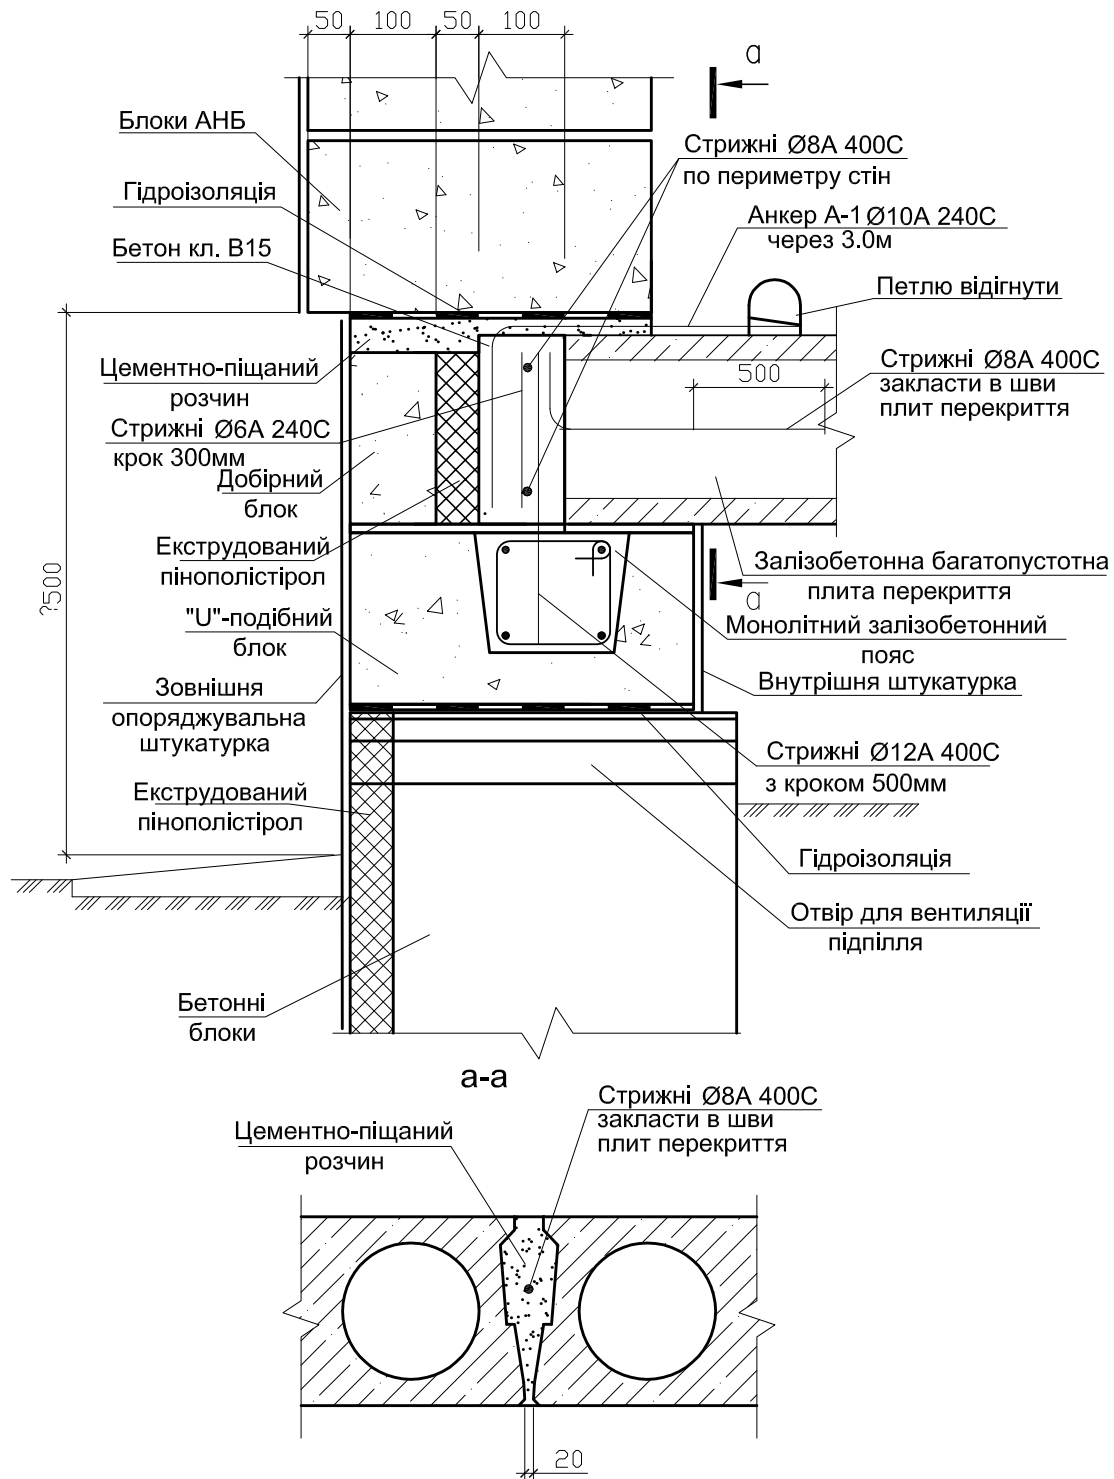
2-5. Влаштування цоколя при залізобетонному багатопустотному перекритті з кріпленням до U-подібного блоку
